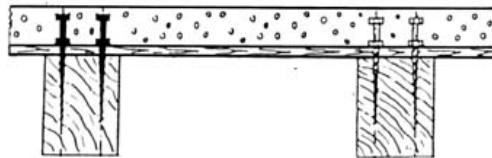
Schweizerisch Technische Zeitschrift (ref. 33)
